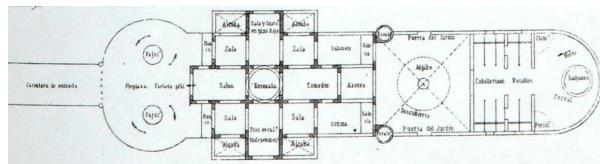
Plano original de la planta baja del Casino del Americano. Fuente: El Artífice, 1869
